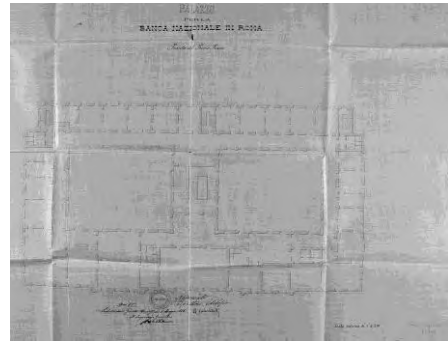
palazzo della Banca d'Italia pianta piano primo, progetto
